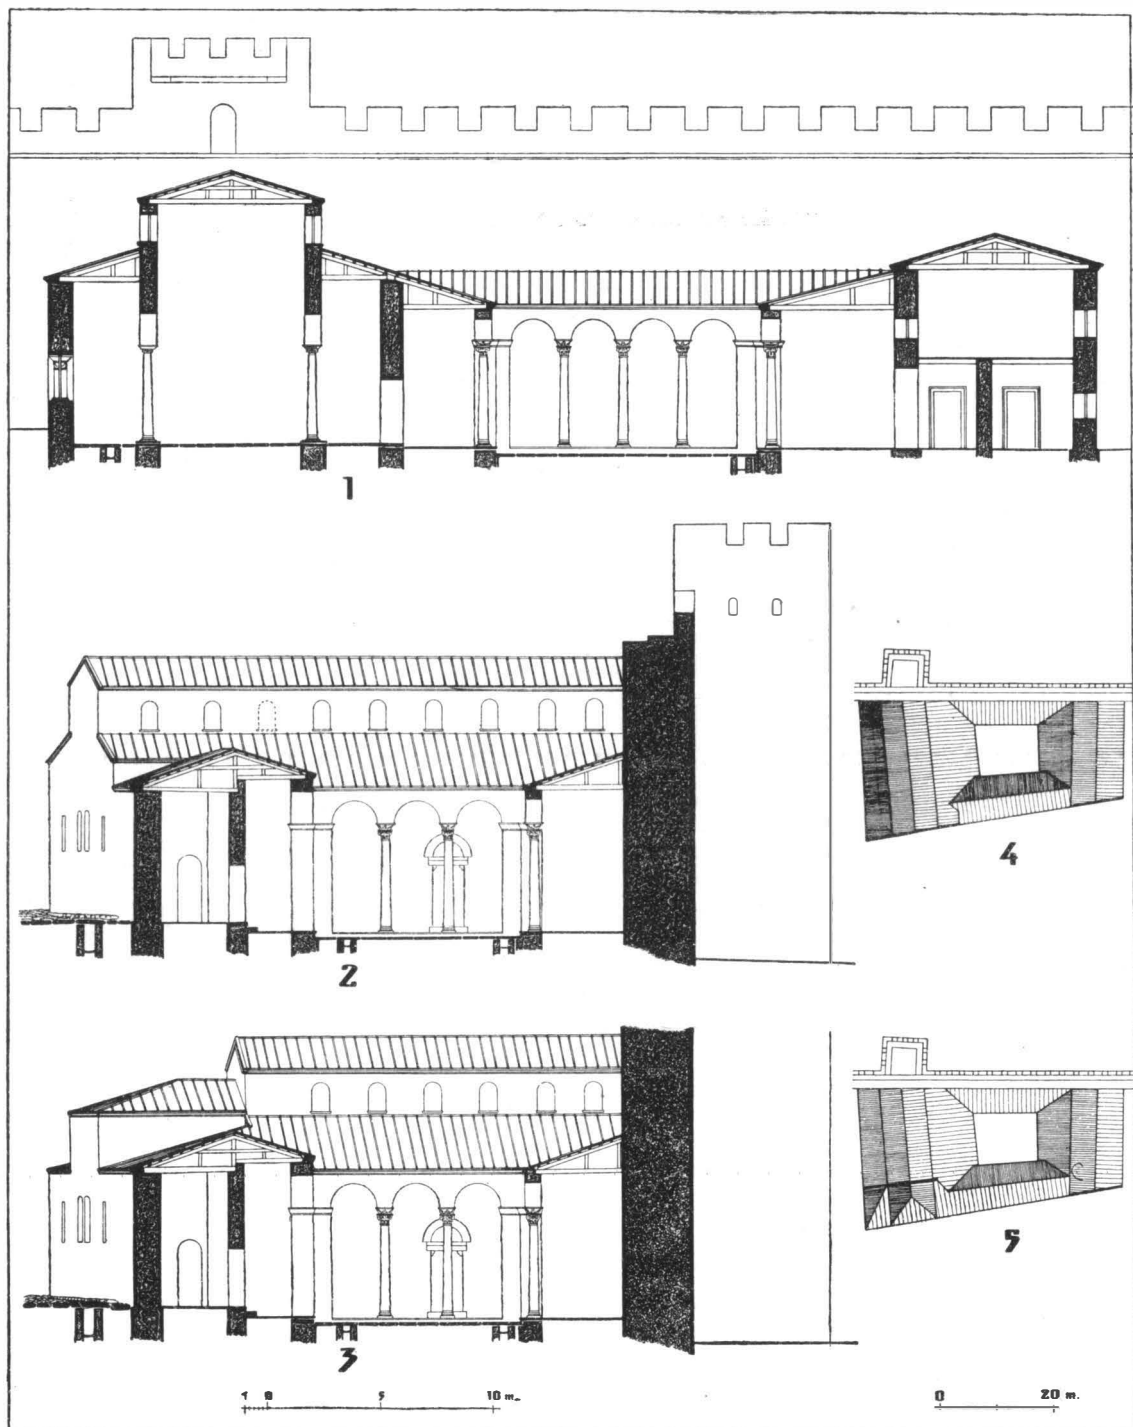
Coupes et toitures — restitutions (voir aussi fig- 4), 1, coupe a—b; 2, coupe c—d; 3, coupe c—d (variante); 4, plan des toitures; 5, plan des toitures (variante).
